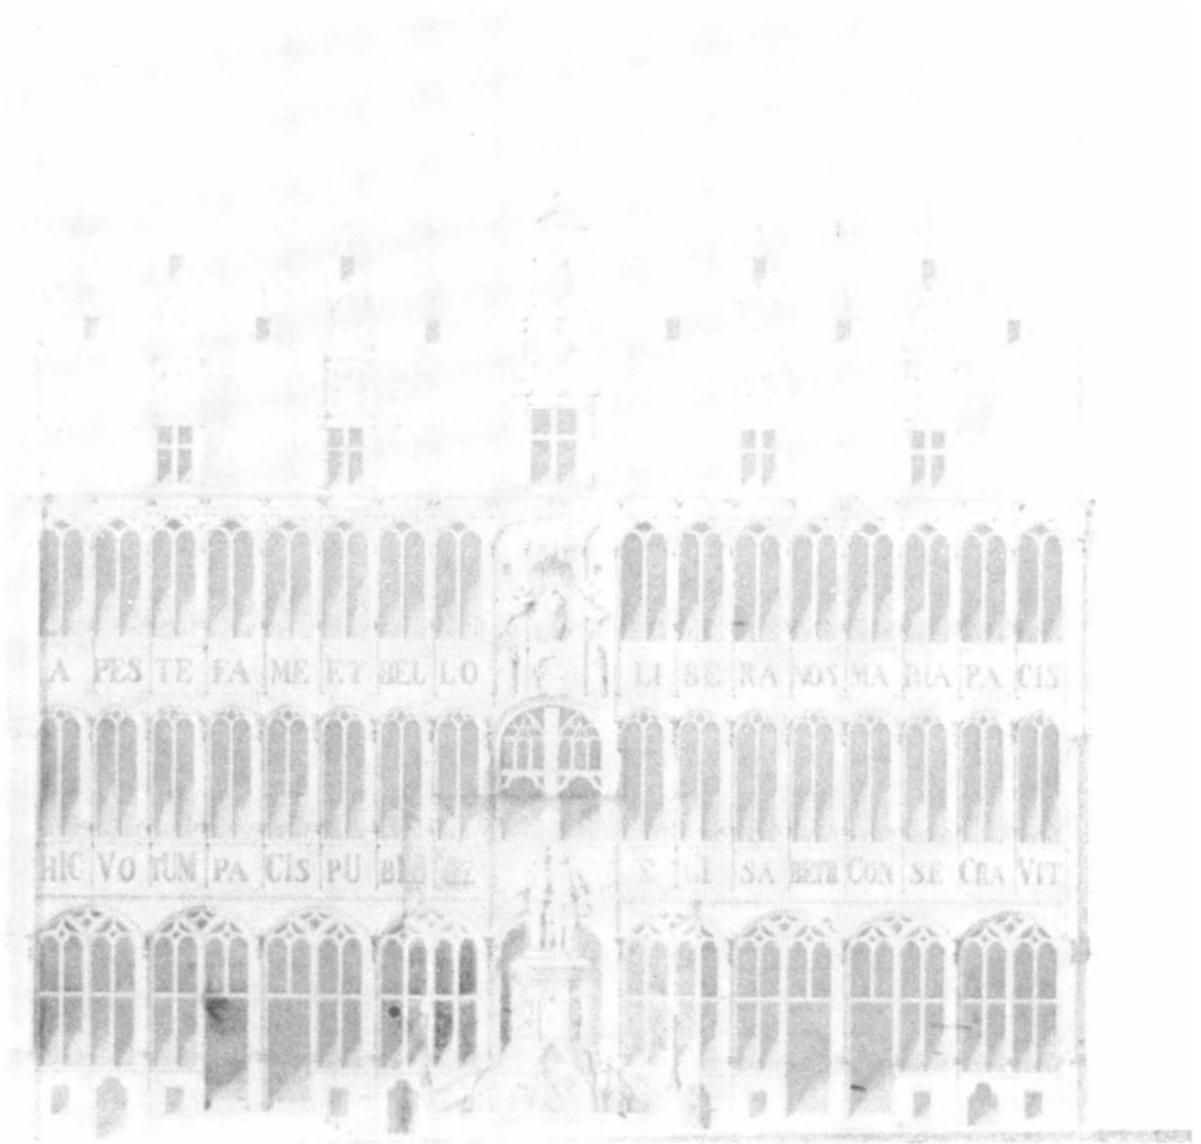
M.d.R., plan de la façade de E. Fierlantz, XIX^e siècle, M.C.
